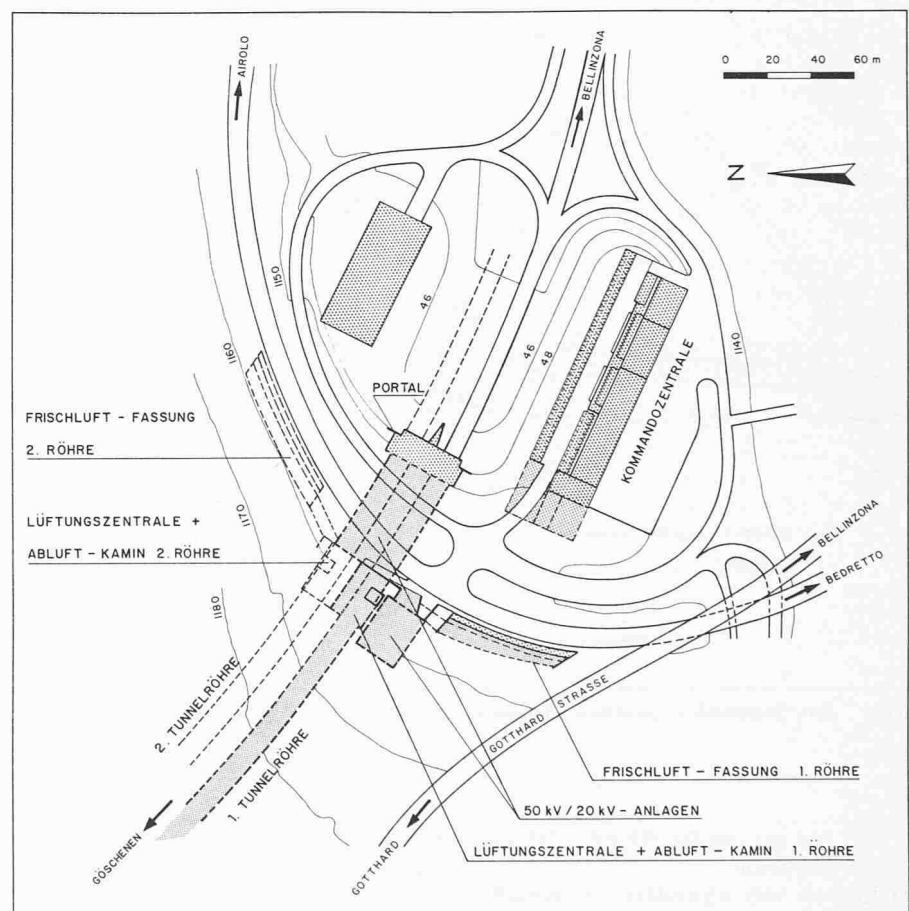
Portalzone Airolo. Disposition der Anlagen im Endausbau mit zwei Tunnelröhren
